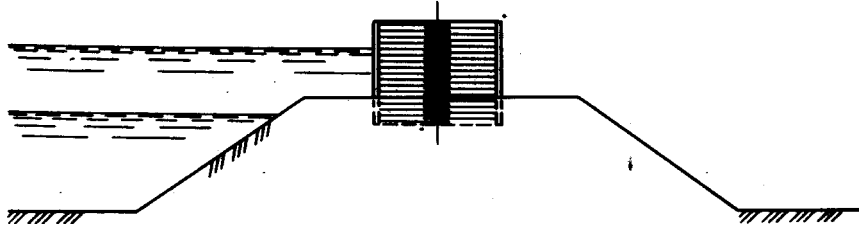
Насыпь с армированием для обеспечения устойчивости
